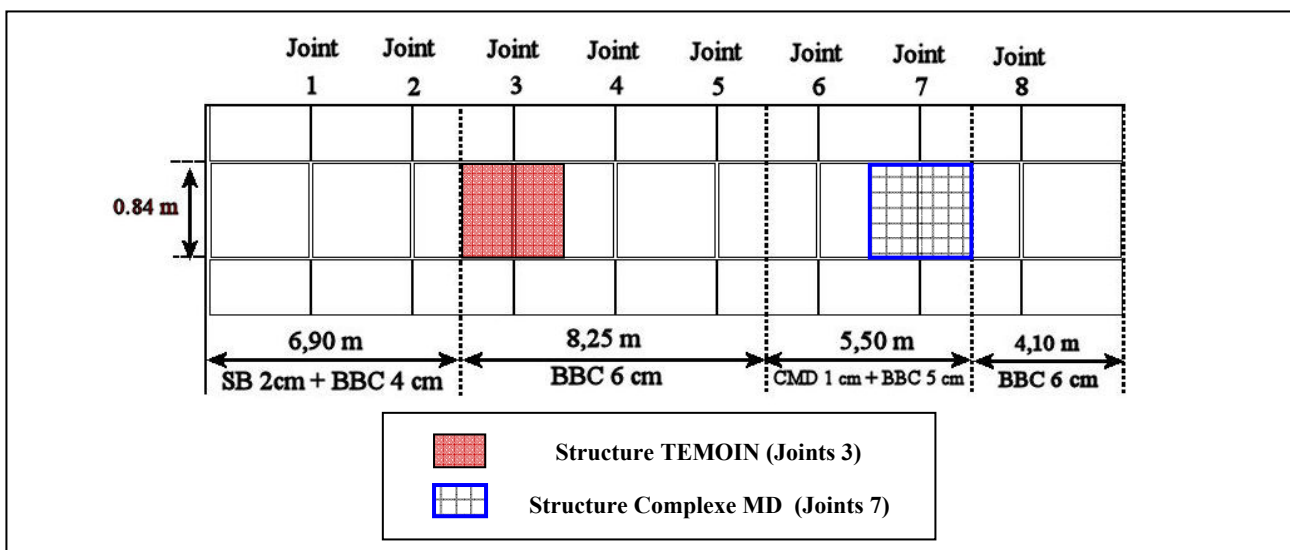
Position des structures Témoin et Complexe MD (sur les joints n° 3 et n° 7) utilisés pour la série d'essai n° 1 de fissuration avec l'équipement FABAC
